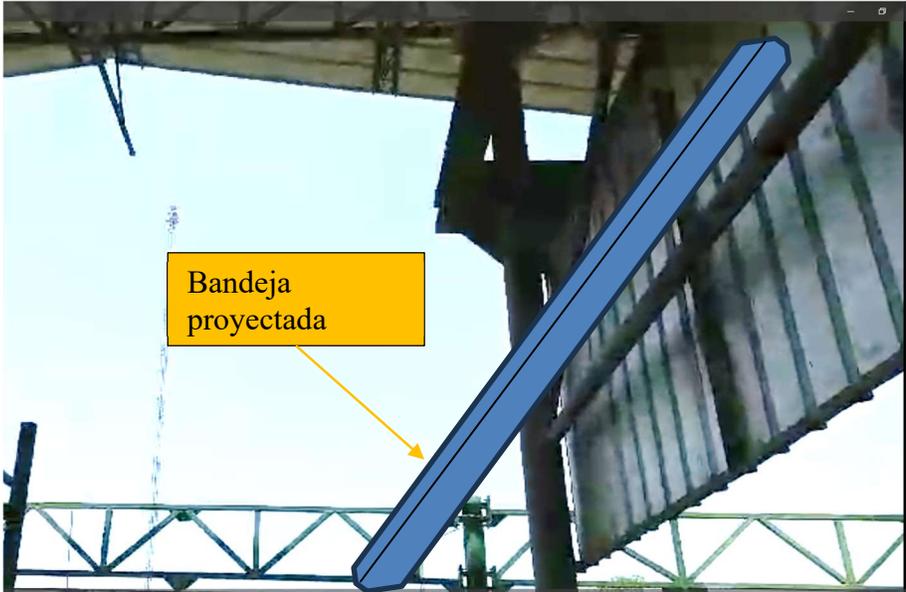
Ubicación de bandeja proyectada con conexión a bandeja existente.
